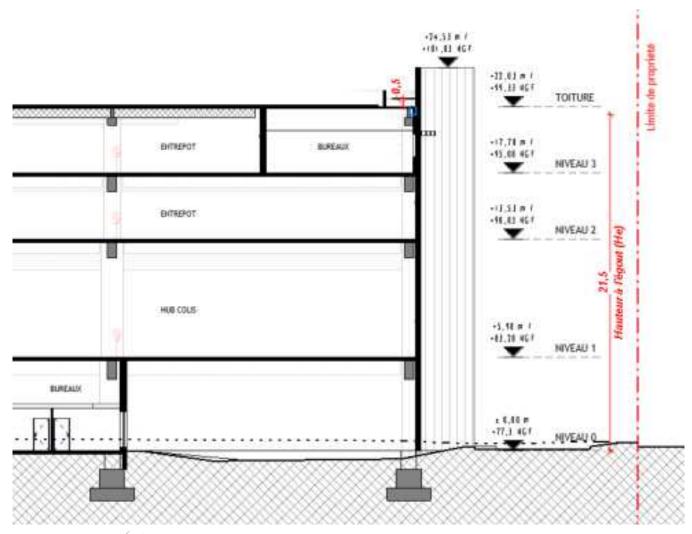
Plan de coupe du futur projet (Source : AECO Archi)
